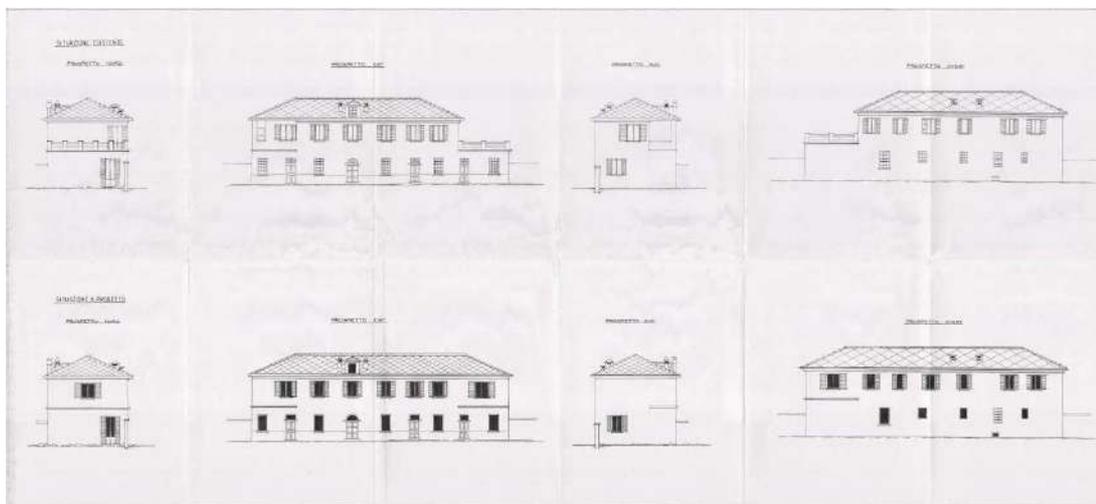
Progetto per la ristrutturazione di locali aziendali. Prospetti Edificio "B" prima e dopo il progetto di ampliamento - 1989
